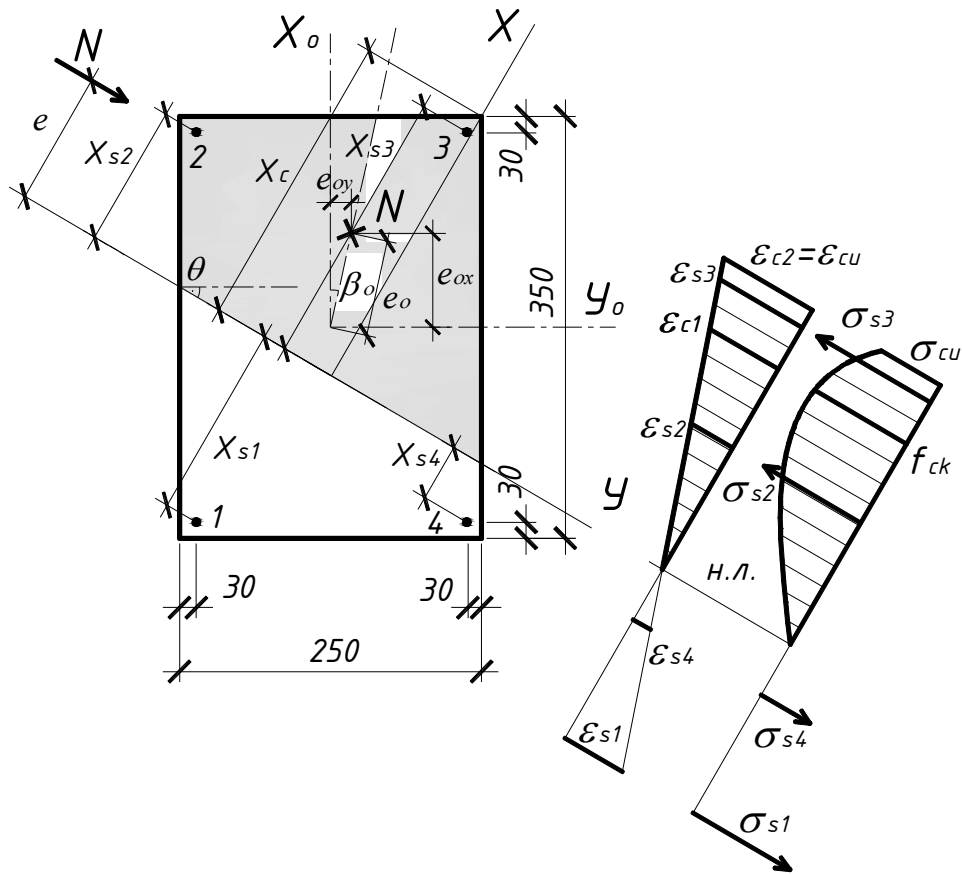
Розрахункова схема перерізу косостиснутої залізобетонної колони до прикладу Г.4
